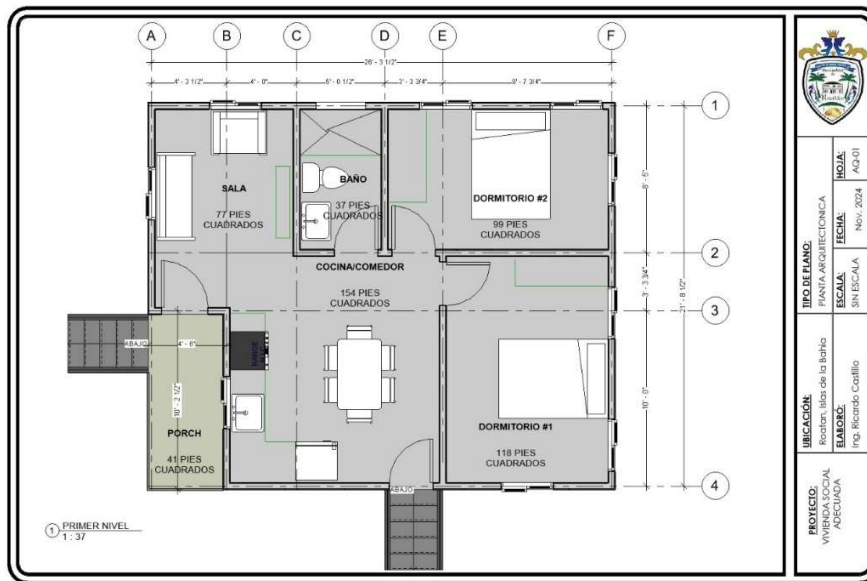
Distribución de espacios en la vivienda social propuesta
